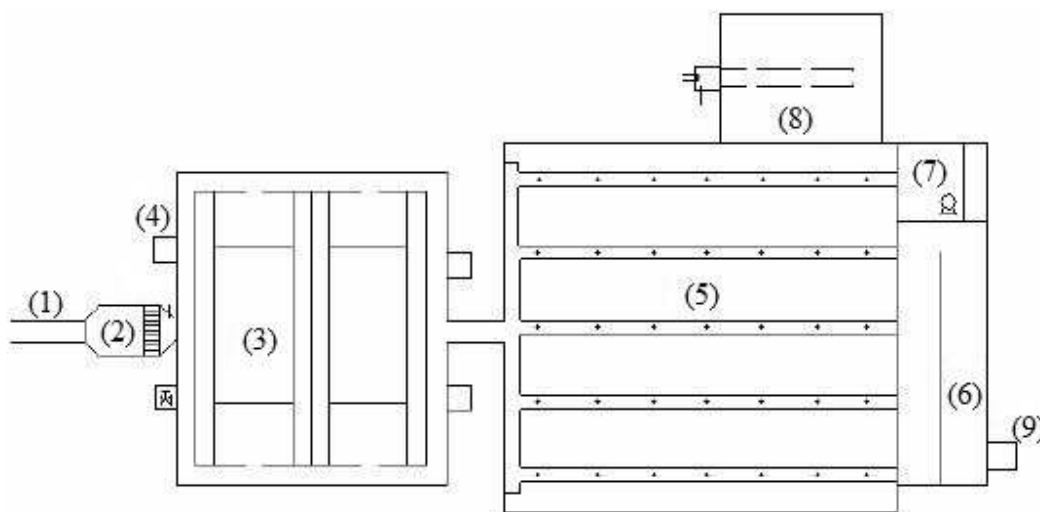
Esquema 1 (Vista en planta de la PTAR de la UCLV)
